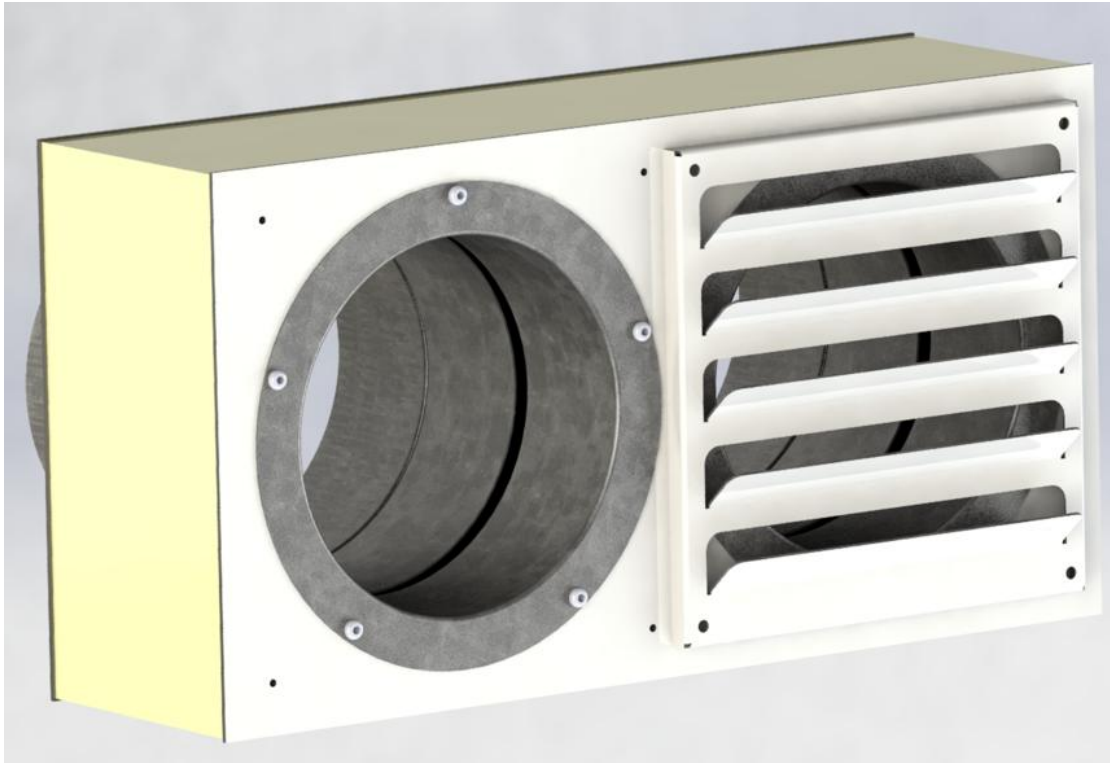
Разметка отверстий крепления решеток внутренней стенки.
